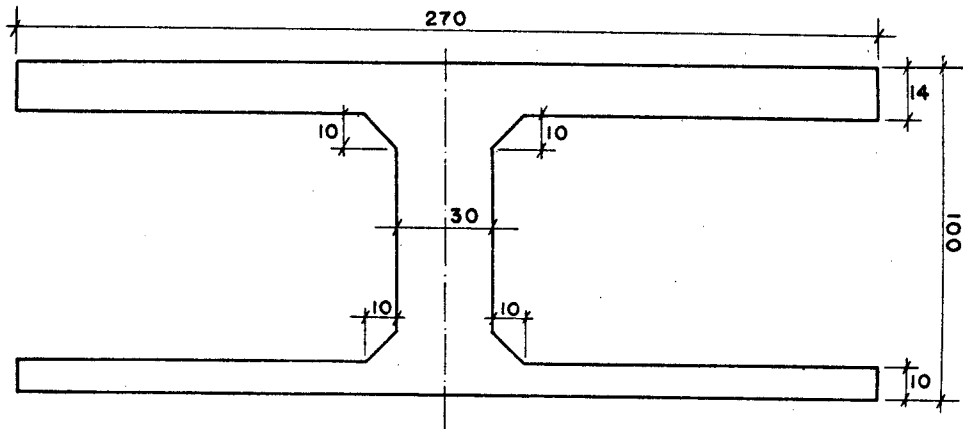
SEÇÃO TRANSVERSAL DA VIGA V2
